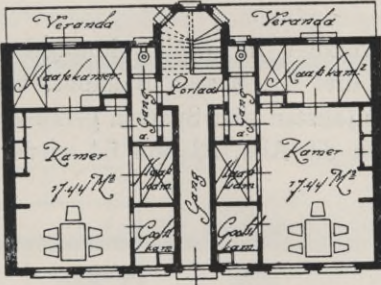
Kleinwohnungen Rotterdam, Erdgeschoß, Erbauer: Gemeinnützige Baugesellschaft.
